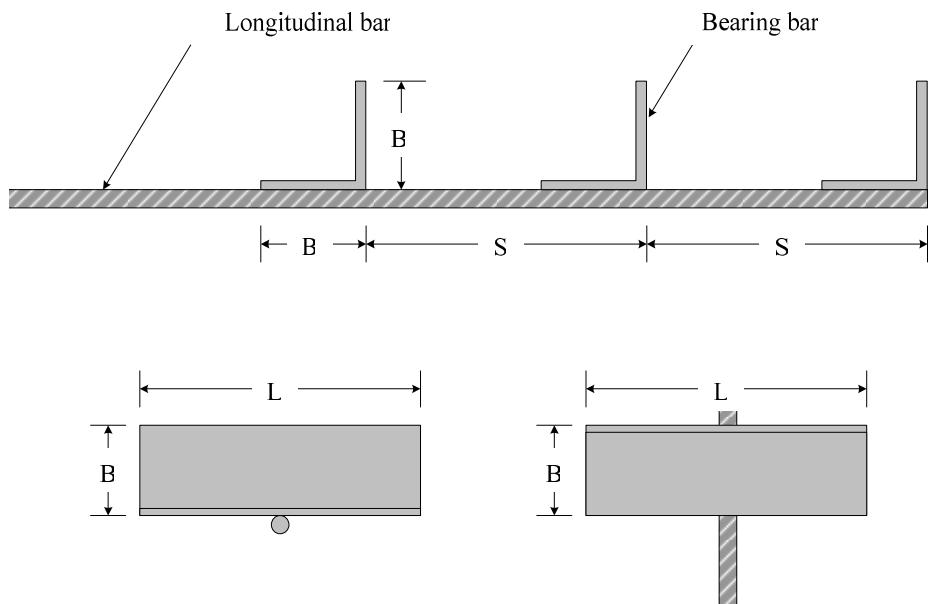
เหล็กเสริมแรงดูดแบบแผ่น (Strip reinforcement)
